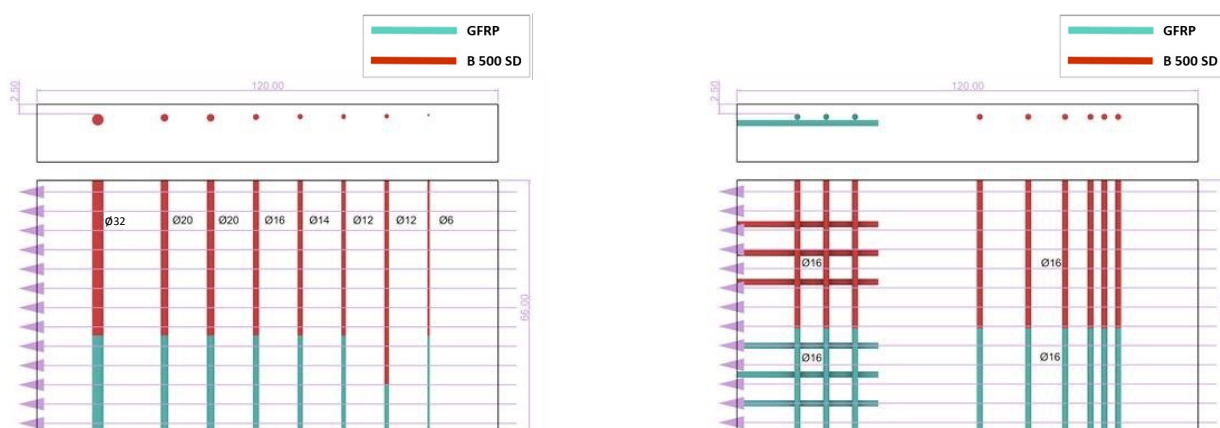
Armadura dispuesta en cada losa: a) Armado de la Losa 1 y b) Armado de la Losa 2
